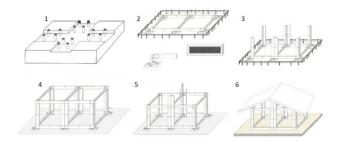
Penampakan Struktur Bangunan Rumah Warga (sumber: Dokumentasi Lapangan, 2018)
